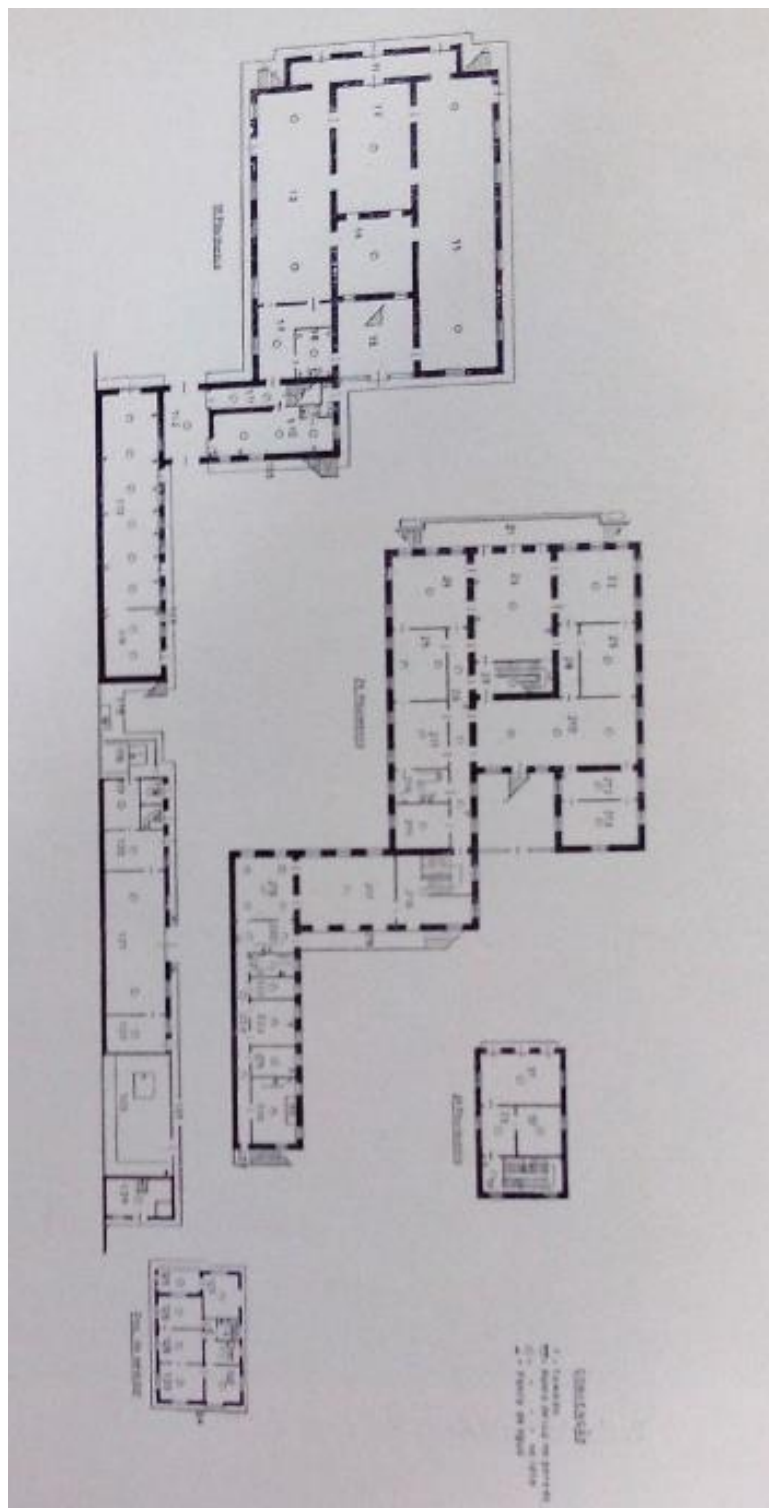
Planta Baixa da Casa de Rui Barbosa³¹⁶.
